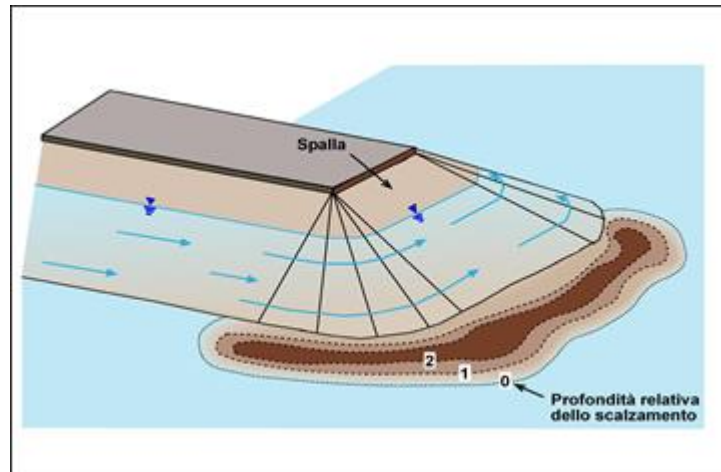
Schema del fenomeno di scalzamento in corrispondenza di una spalla.
